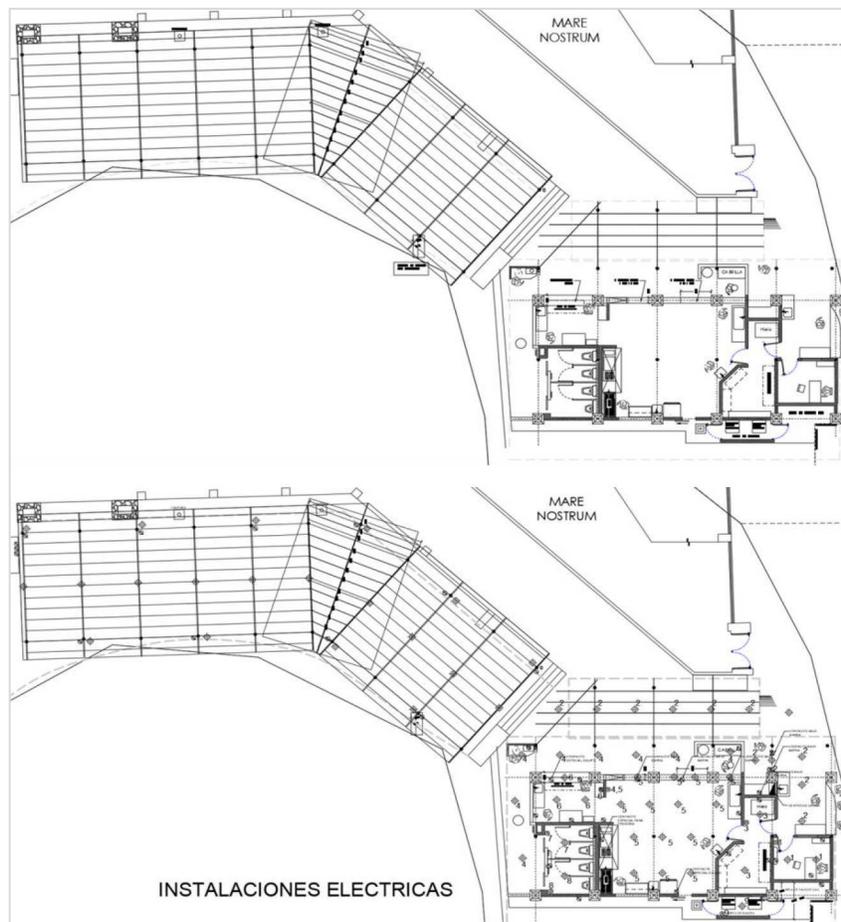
Planta de conjunto arquitectónico con la instalación eléctrica de la pérgola con estructura de fierro con techo de lámina ocre.
